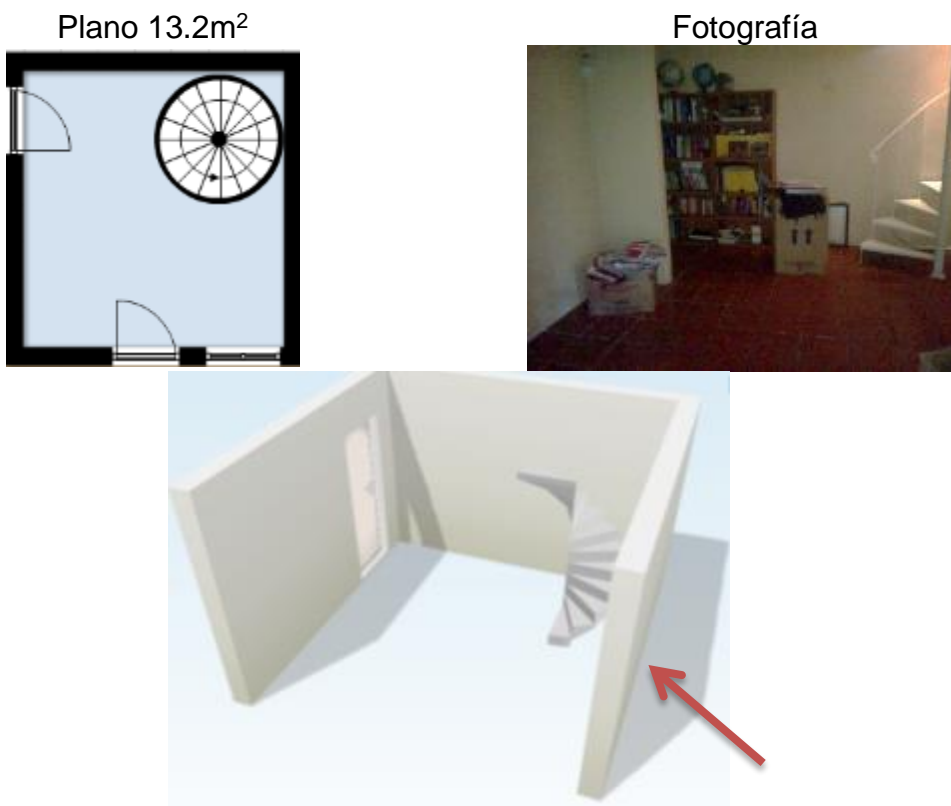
Vista interior de la modificación estructural de la segunda entrada y plano
